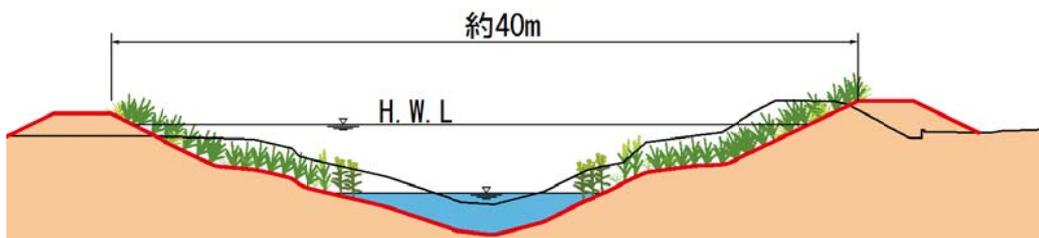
本庄江整備計画平面図（工事施行の場所）及び代表断面図
